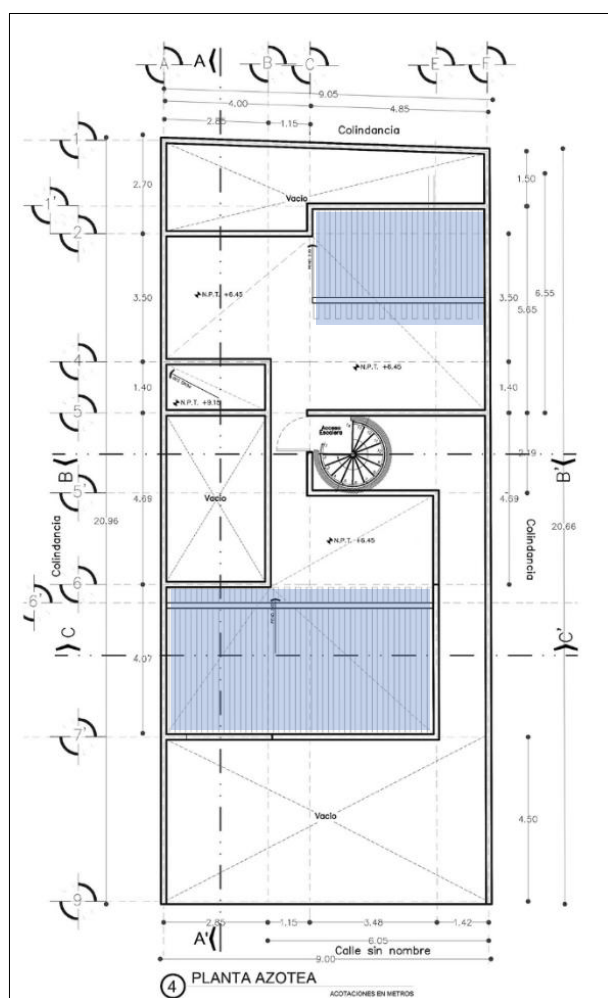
Plano arquitectónico Planta Azotea primera propuesta. Elaboración propia. (YPHC 2025)
